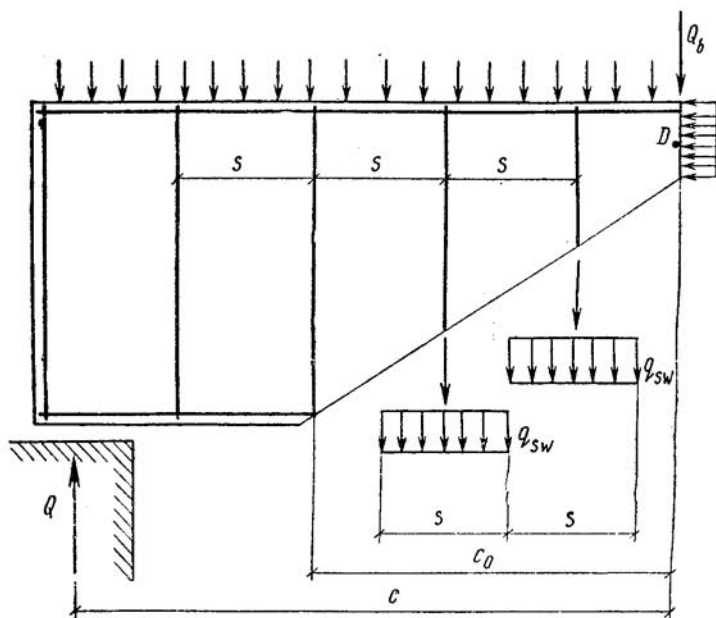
Усилия в поперечных стержнях, принимаемые при расчете балки по наклонным сечениям
